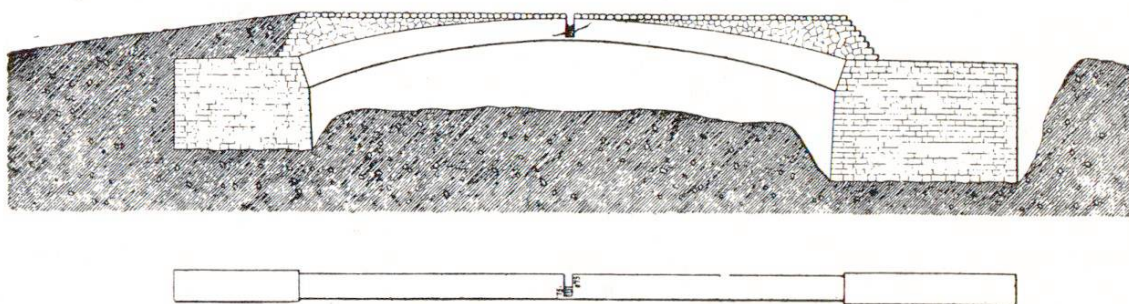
Elévation et plan de la voûte au moment où le voussoir de clef était réduit à une épaisseur et une longueur minima
